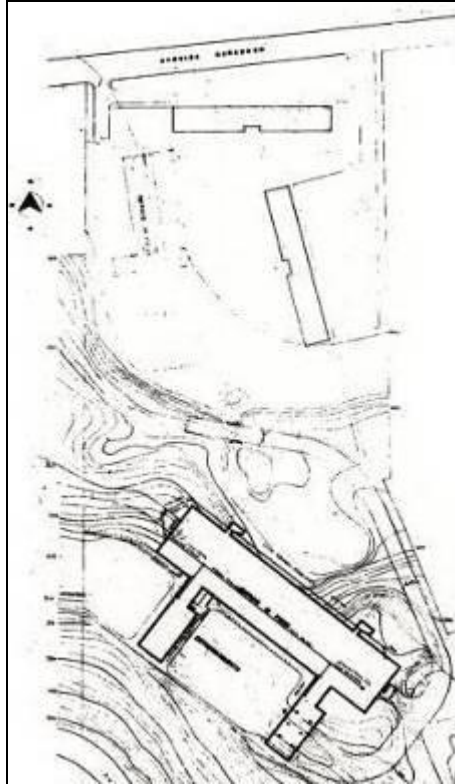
h. UR El Paraíso. Plano de Conjunto. Obra ejecutada (1954)
